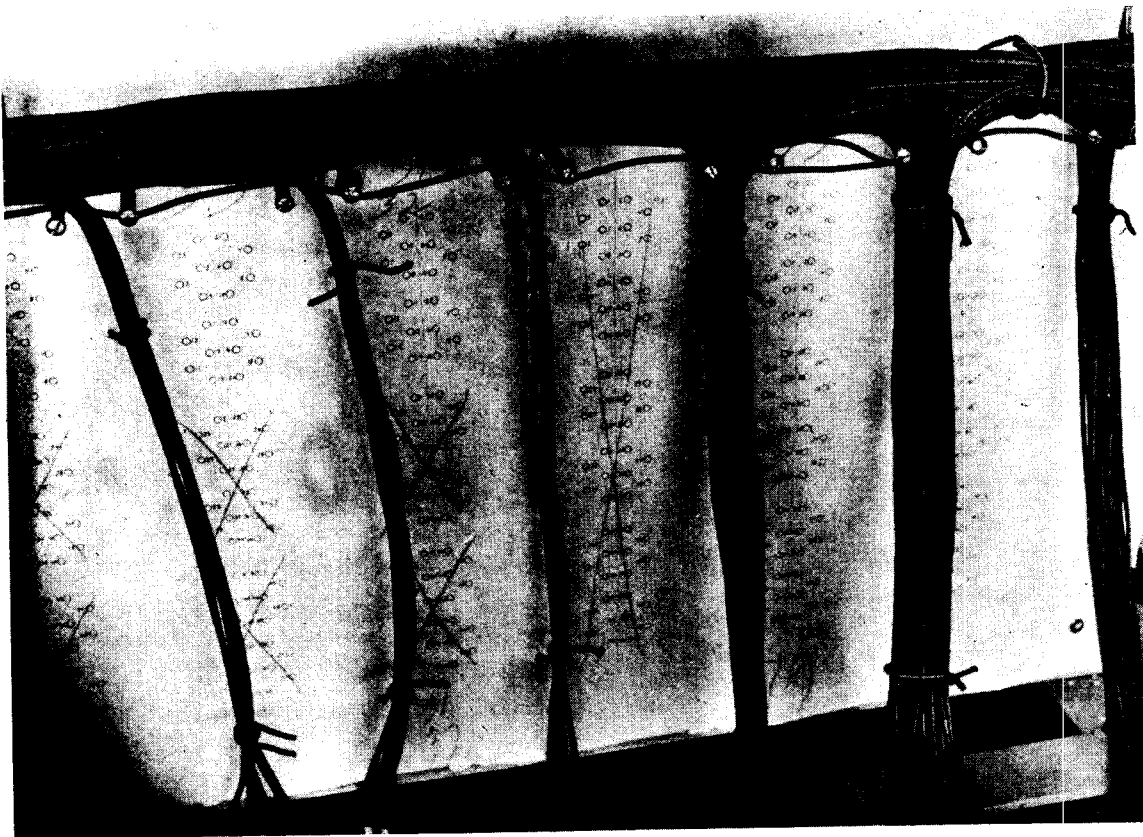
Eksempel der viser, hvordan Ledningernes Bøjning sker ved Hjælp af Skruer med Paprørsbeskyttelse.
